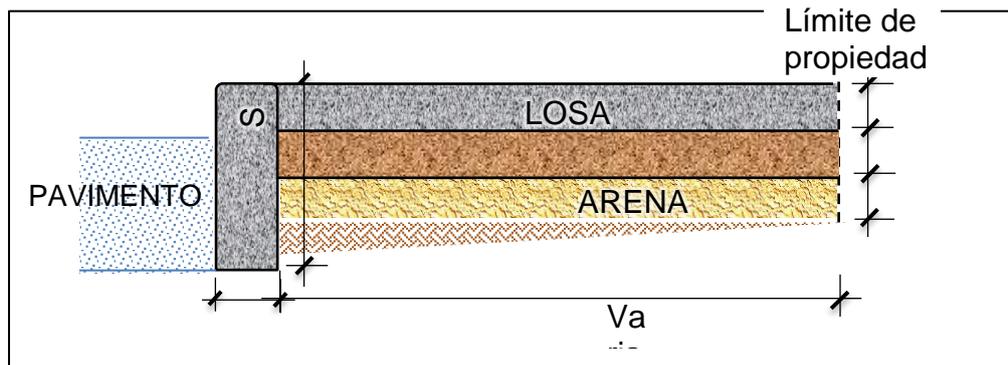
Detalle de vereda adyacente a calzada.
